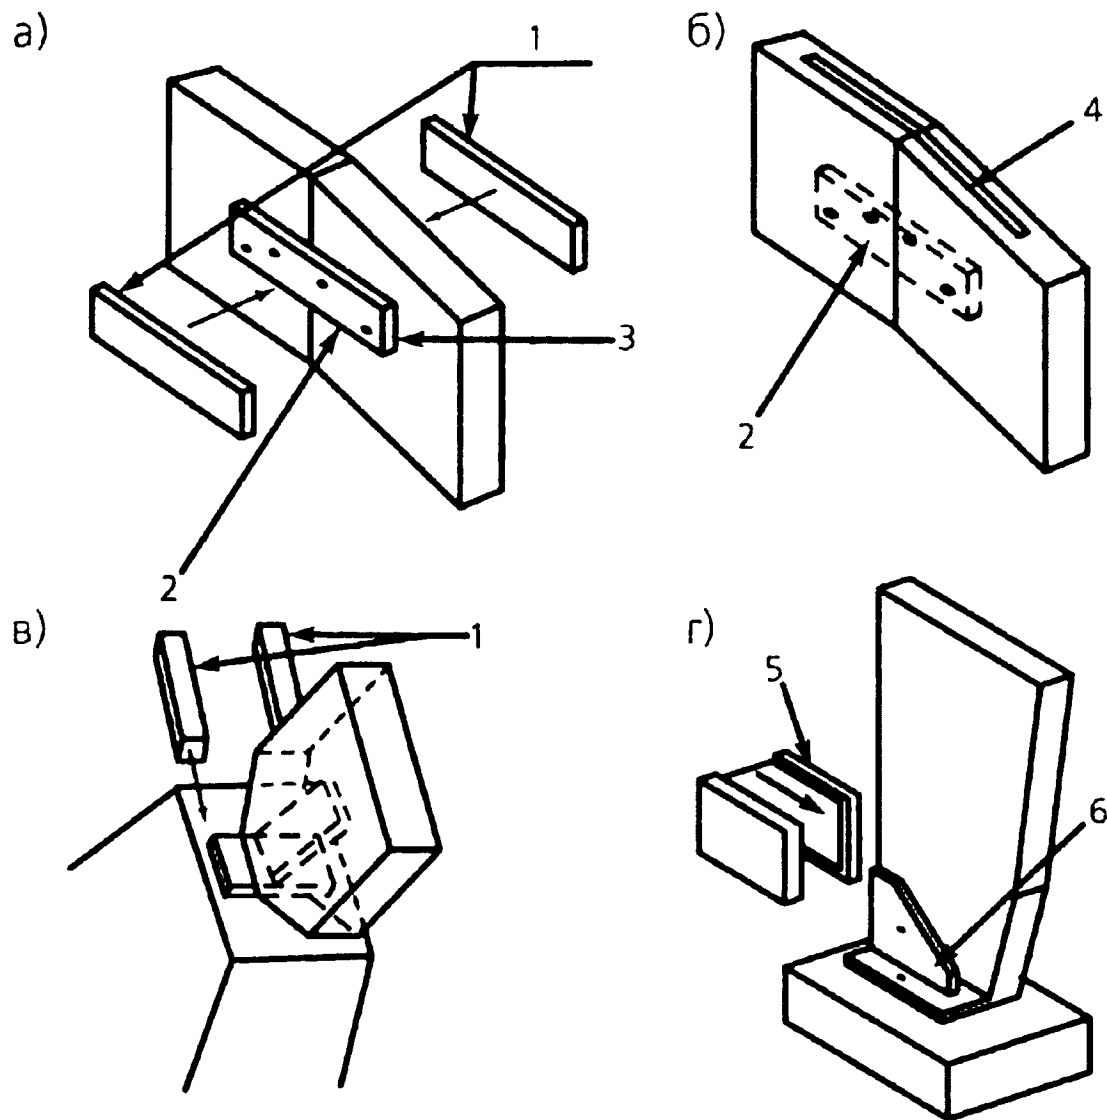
Конструктивная огнезащита узлов клееных деревянных конструкций: а, б - конькового узла, в - опорного узла арки, г - опорного узла рамы; 1 - защитные накладки; 2 - стальная накладка; 3 - прокладка; 4 - прорезь; 5 - защитный чехол; 6 - стальной башмак
